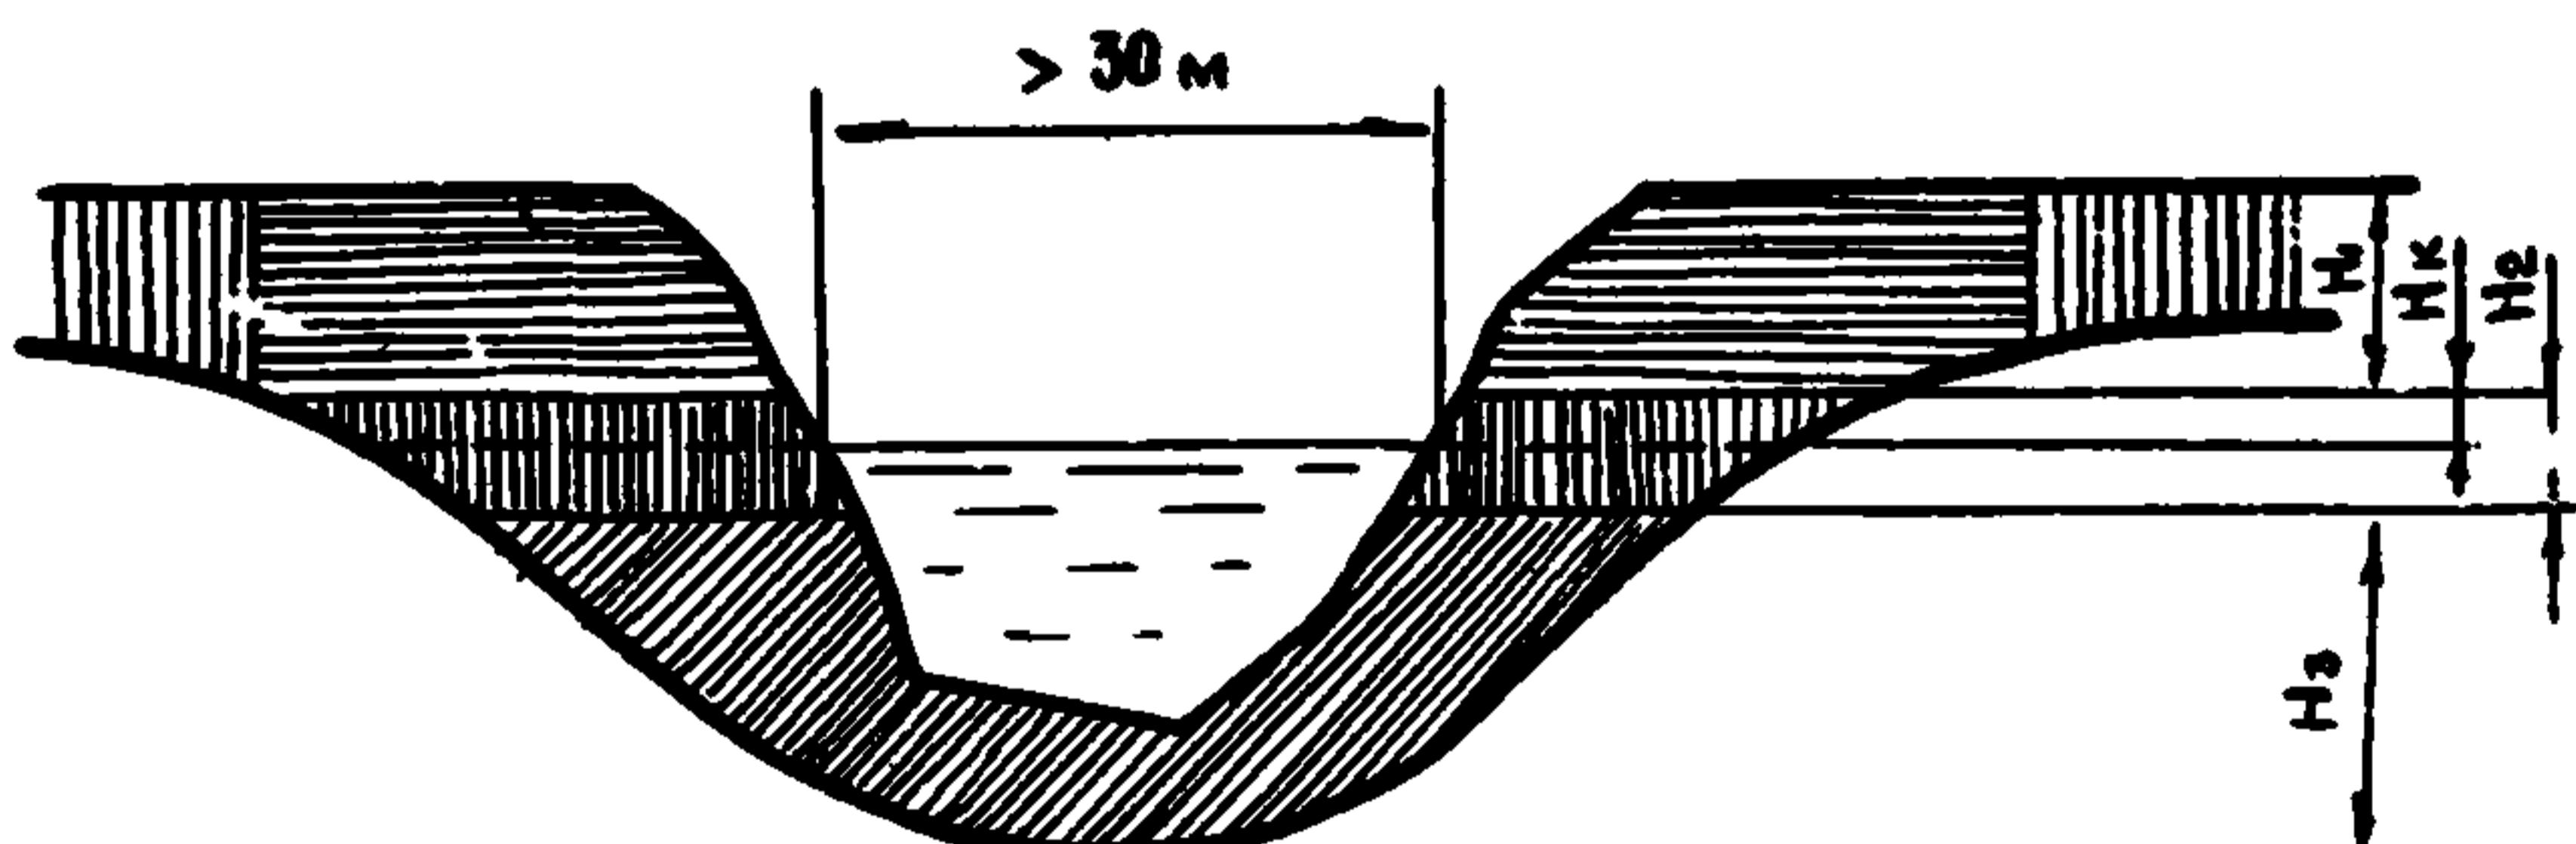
Технологическая схема разработки траншей на подводных переходах магистральных трубопроводов:
